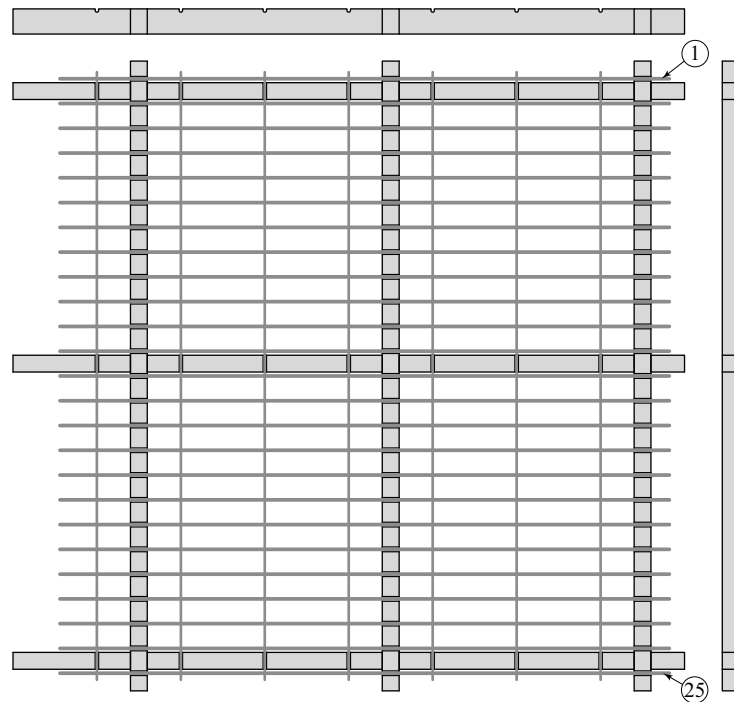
Holzrahmen zur Aufnahme und Positionierung von Bewehrungsstäben.
